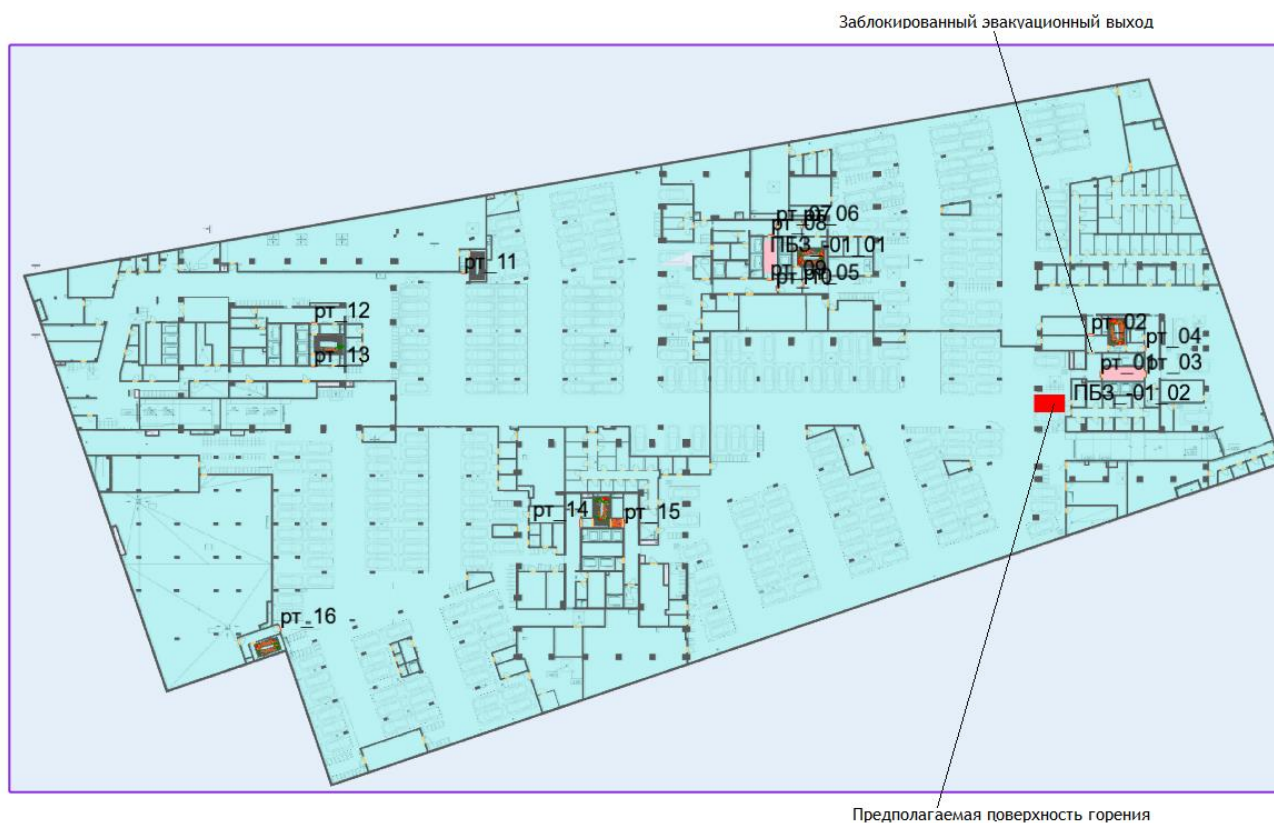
План минус 1-го этажа и нанесенная на него расчетная (принципиальная) схема эвакуации (расположение людей на момент полной эвакуации с этажа пожара – 3 мин. 6 сек.)
